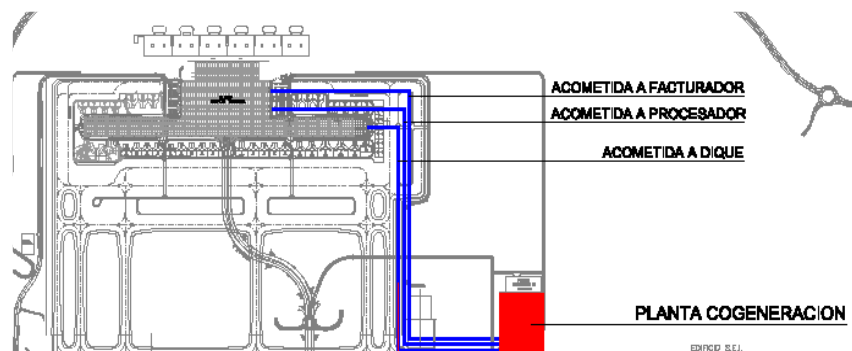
Plano de emplazamiento y acometidas. Planta Cogeneración.
